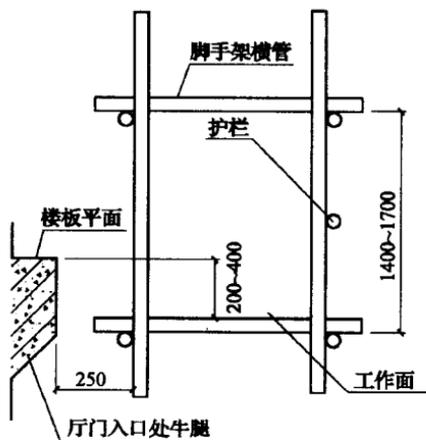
厅门牛腿处脚手架搭设示意图
